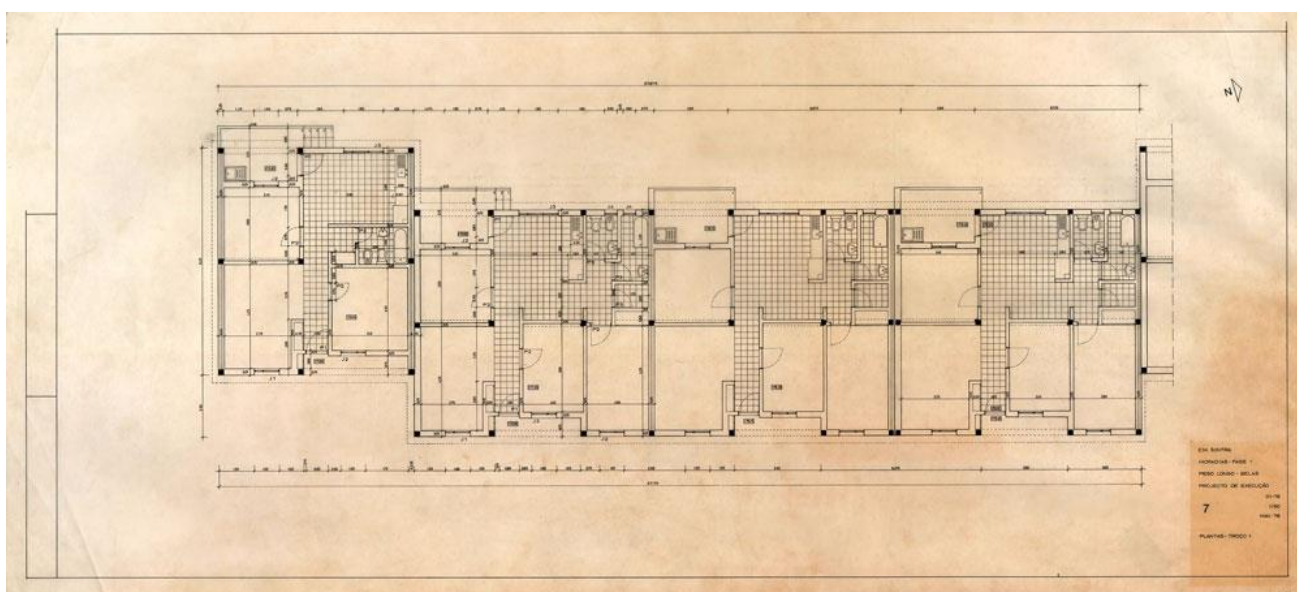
Planta Tipo. Fonte: © Fundação Marques da Silva, Bartolomeu Costa Cabral
